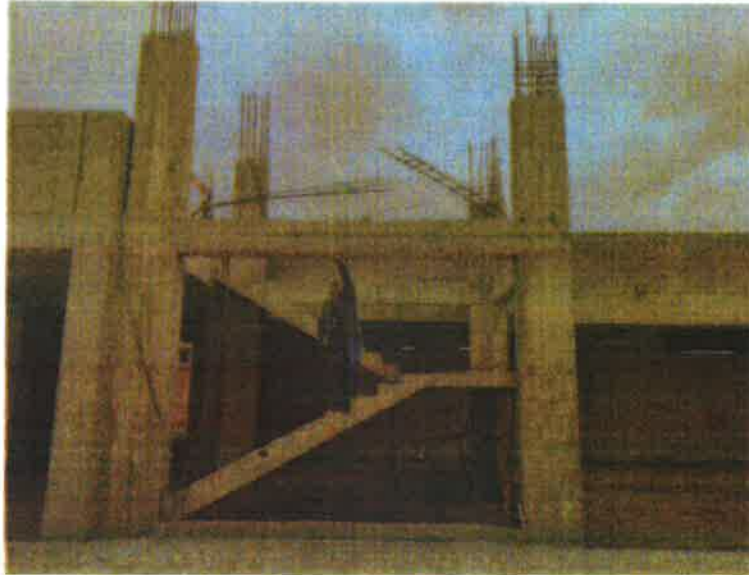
En la siguiente imagen se aprecia el estado actual de la escalera del bloque 6, donde se visualiza que faltan los elementos estructurales del segundo piso como columnas, vigas y losa aligera, además de las divisiones (tabiques) y acabados.
